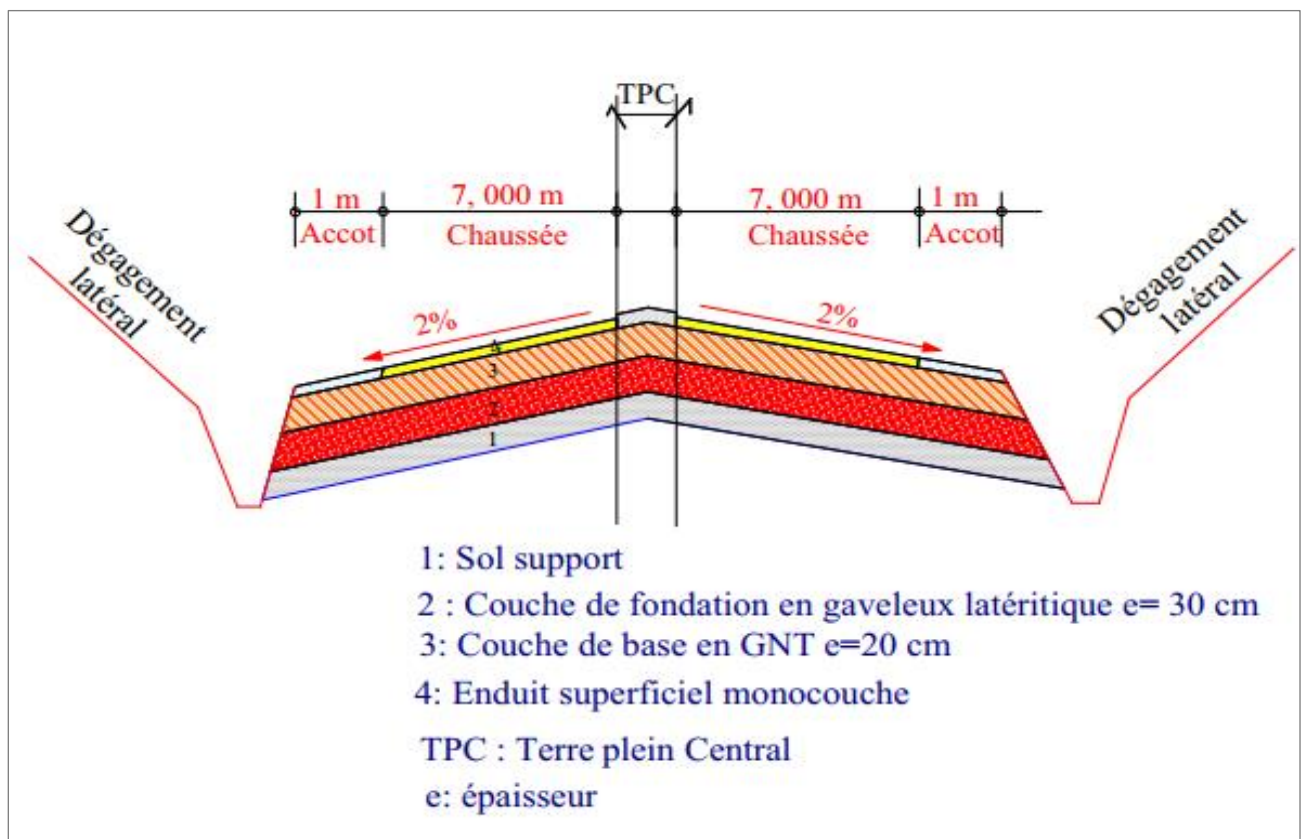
Coupe transversale sur la chaussée (source :DDIT Lokossa)
